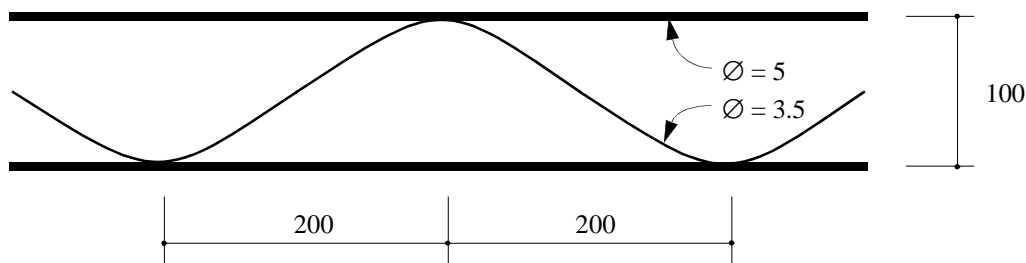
Lagerfugenbewehrung Murfor[®] Typ 5 / 10. Abmessungen in mm.
